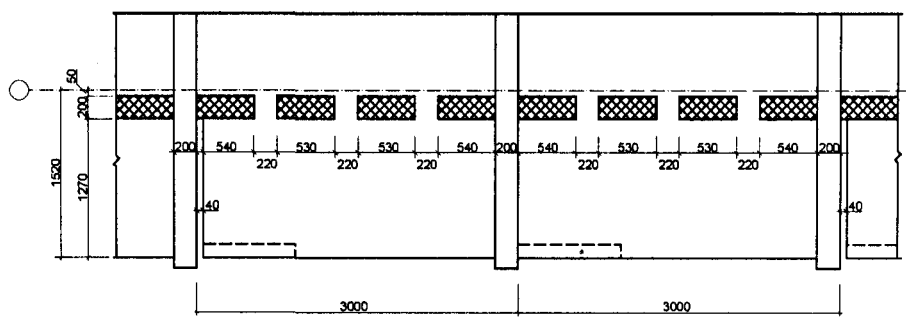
Детали перекрытий (монолитный железобетон)
